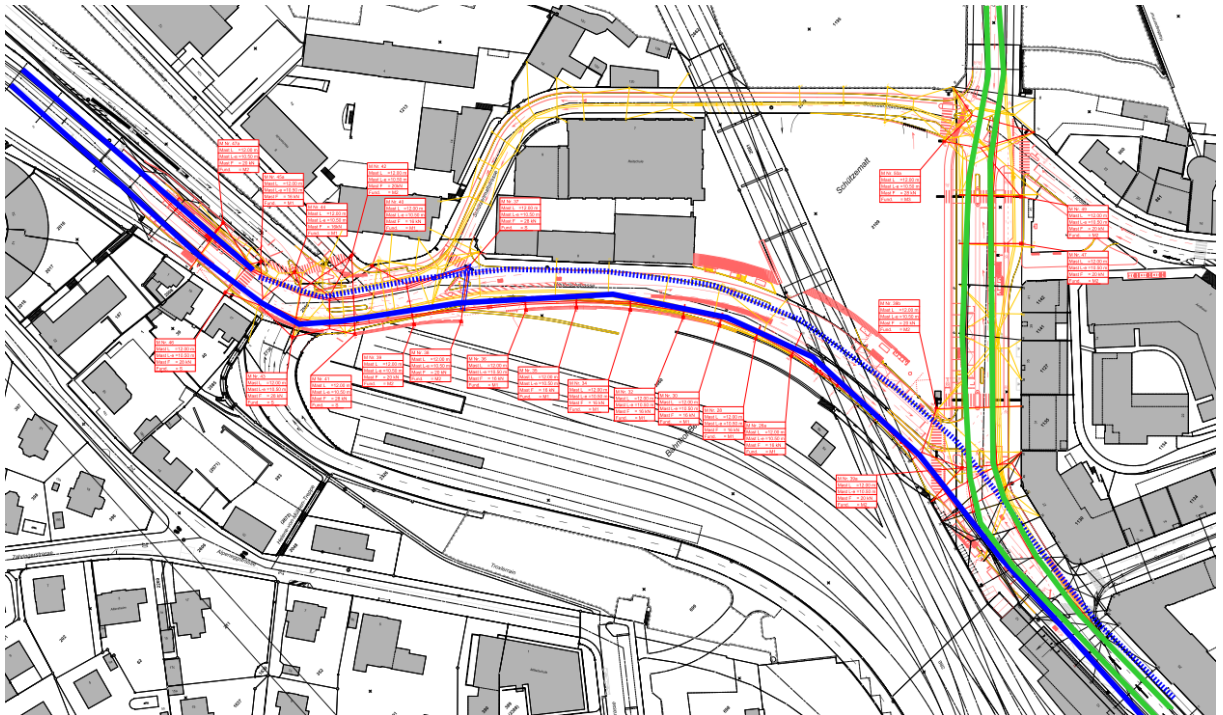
Trolleybusfahrleitung Baustein 3b
